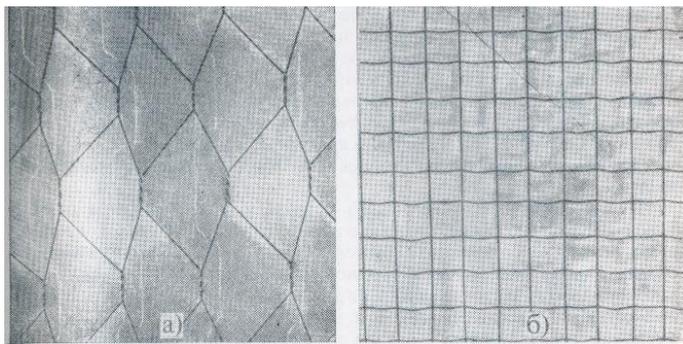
Армированное стекло: а) с крупными и б) мелкими ячейками
